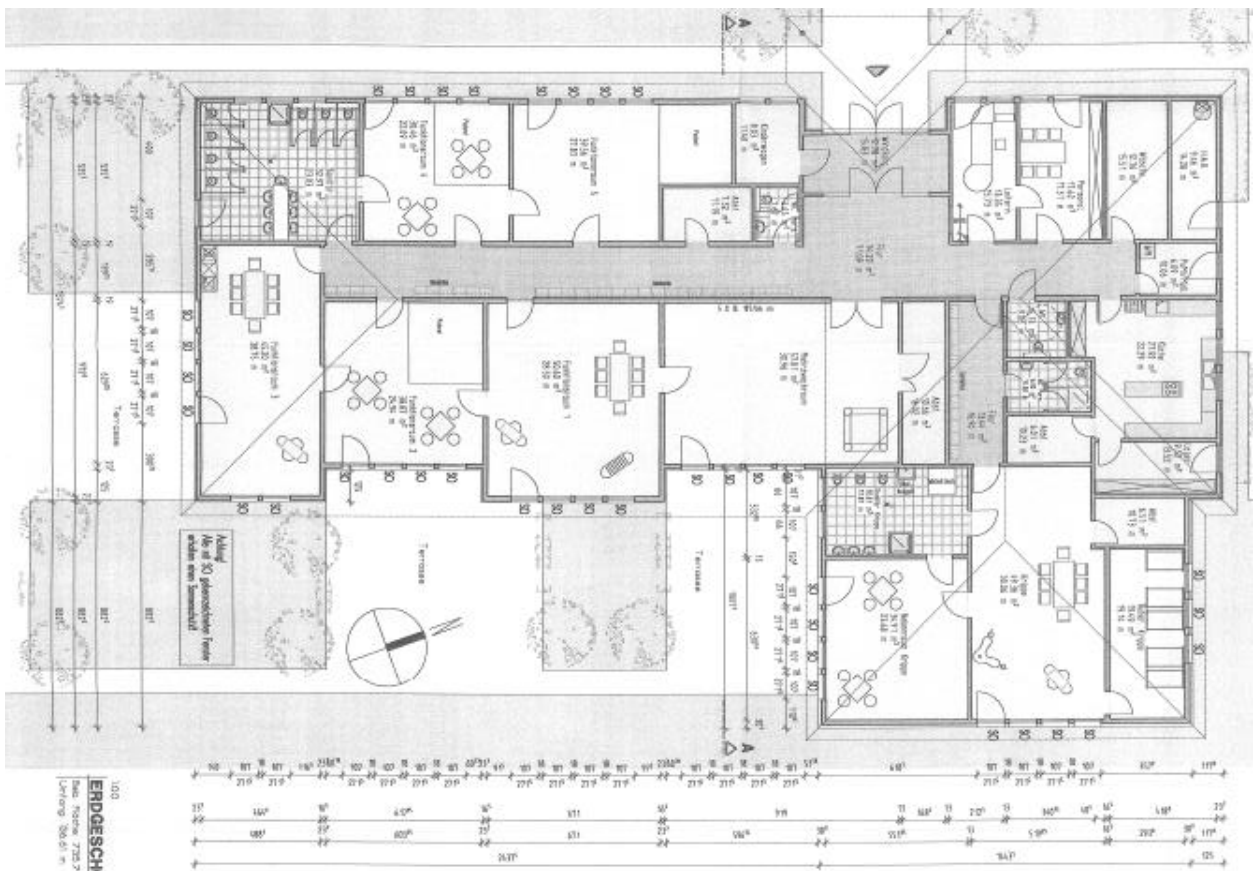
Grundriss des Kita-Gebäudes
